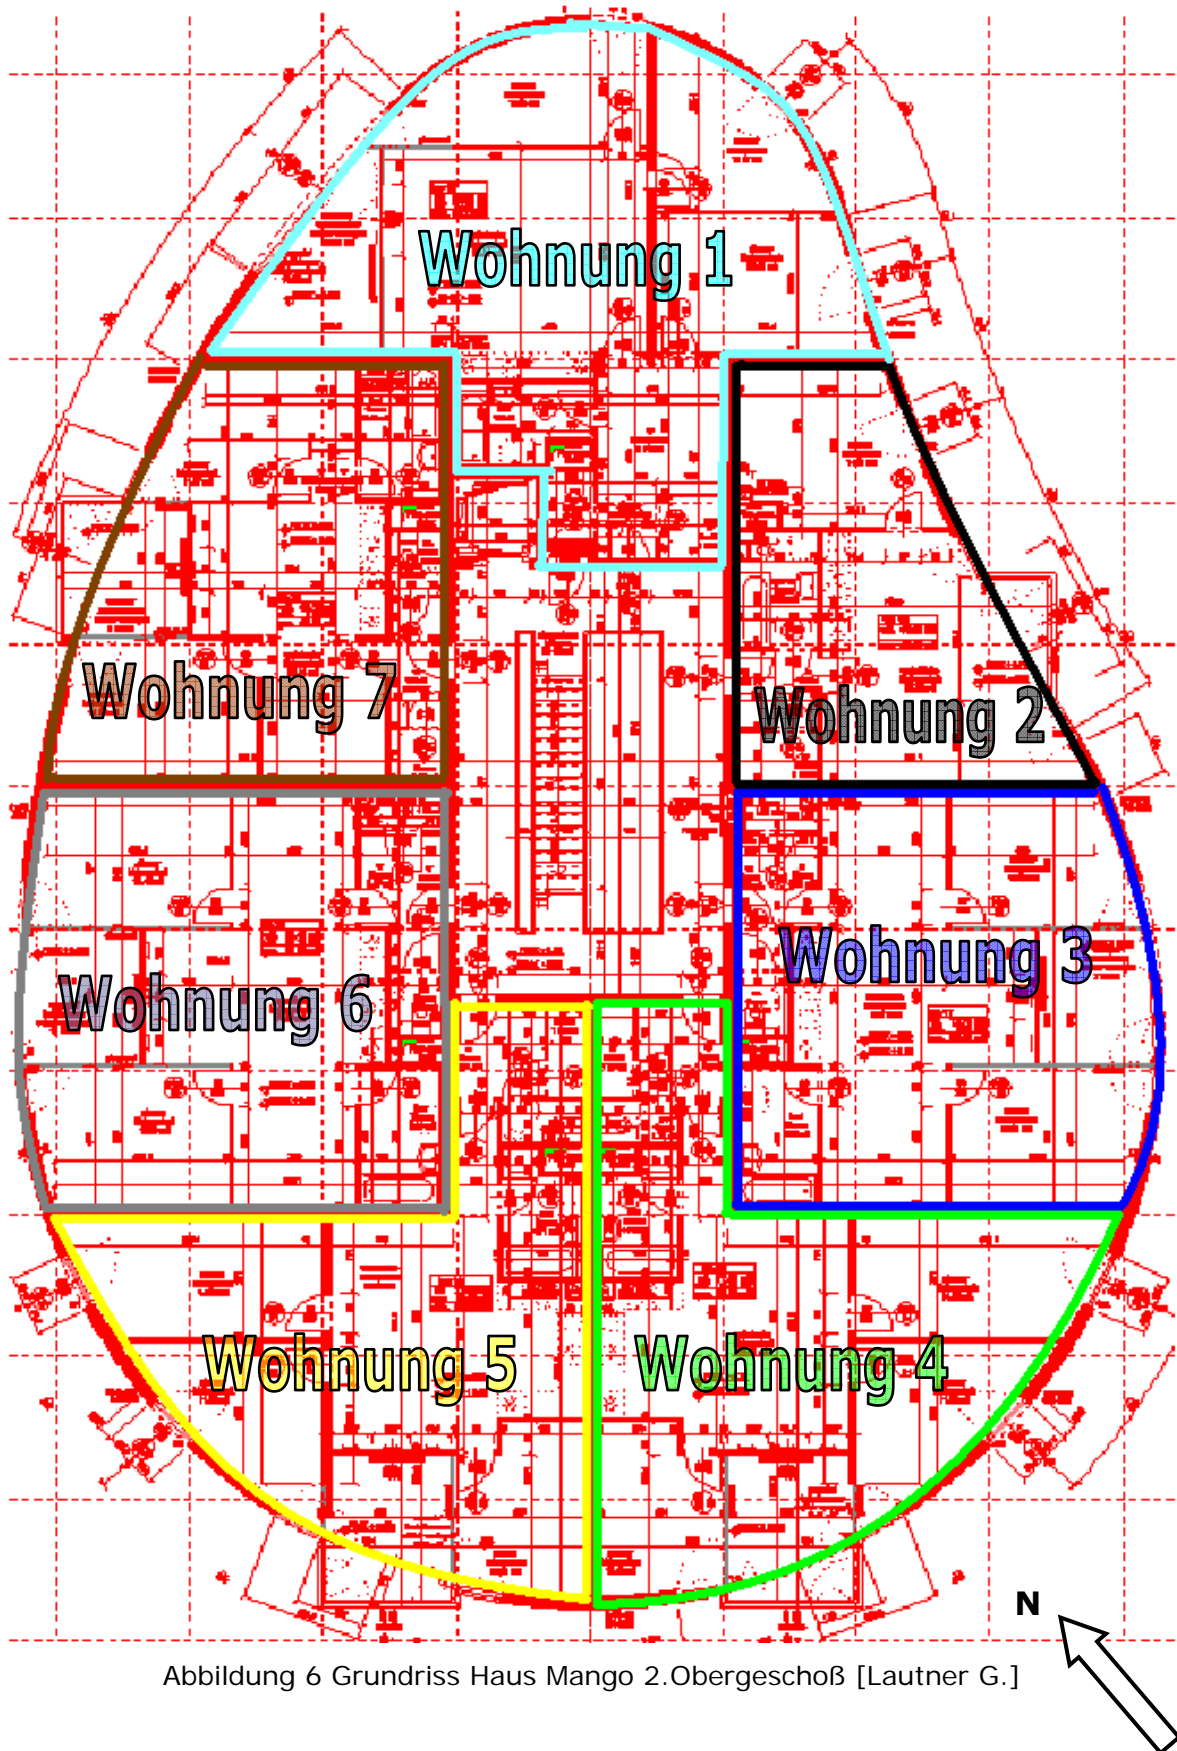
Grundriss Haus Mango 2.Obergeschoß [Lautner G.]
